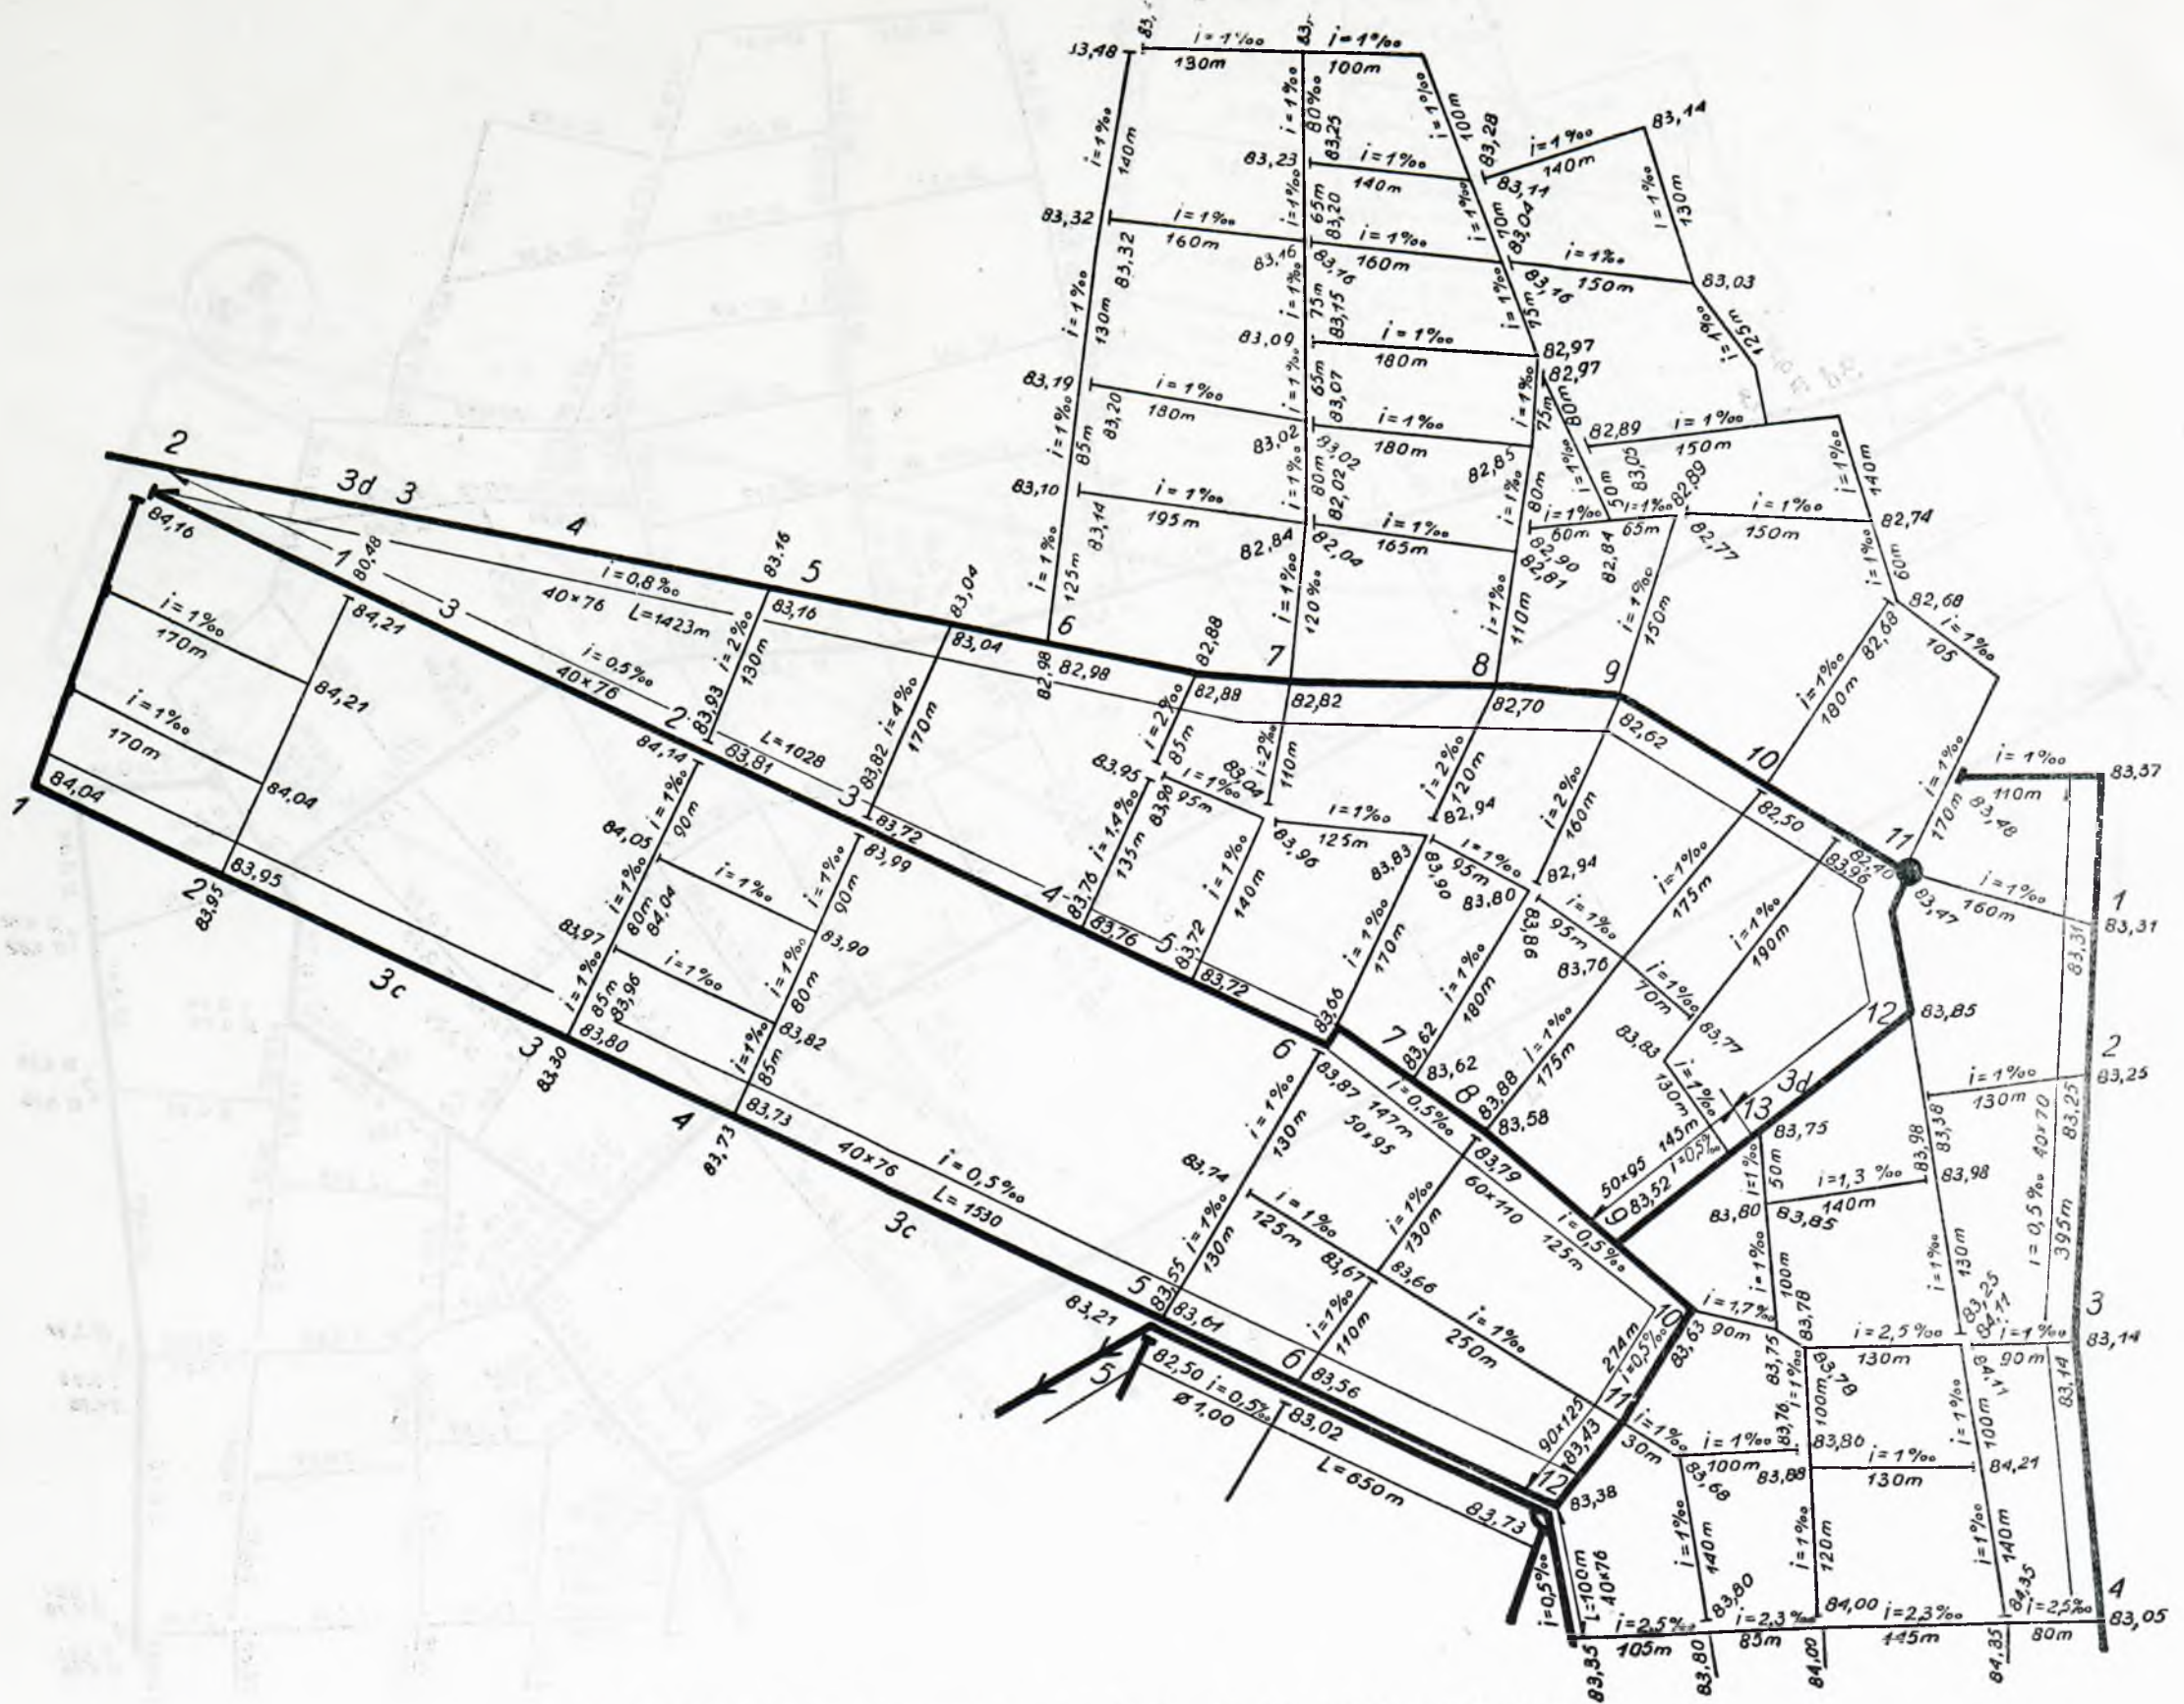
Układ sieci przewodów kanalizacyjnych z za znaczeniem przekrojów, długości, spadków i miejsca studzienek wjazdowych
